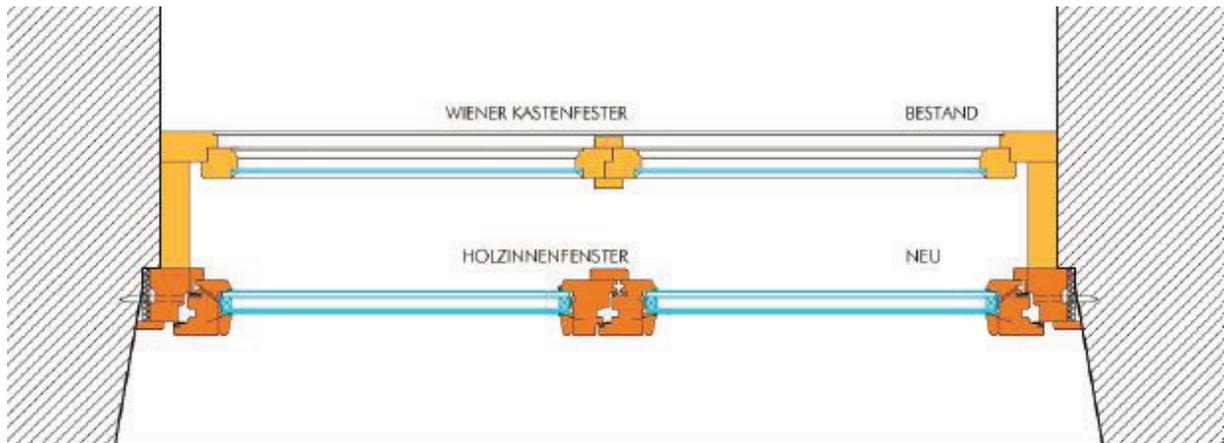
Kaiserstraße, Fensterdetail Waagschnitt (Quelle: AKP)
